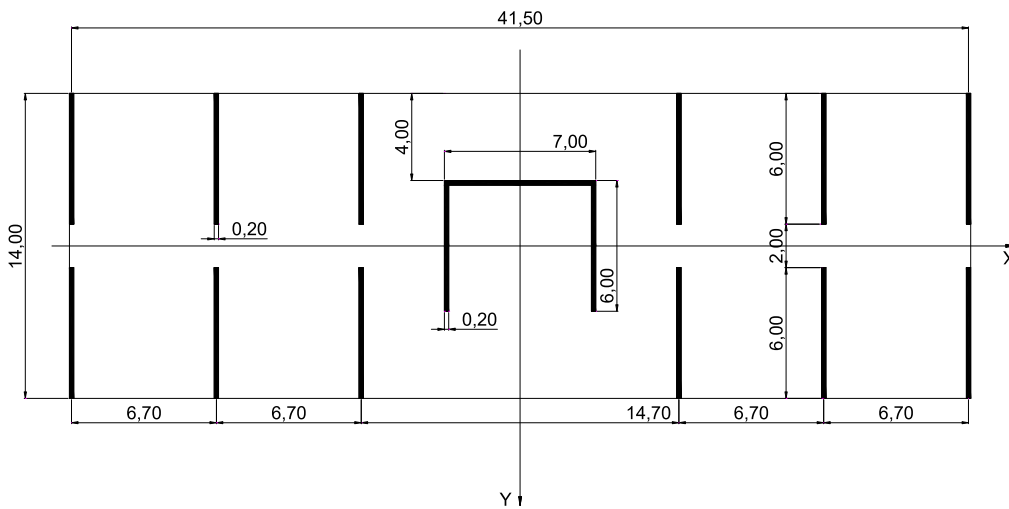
Planta típica del edificio con Núcleo y Tabiques.
